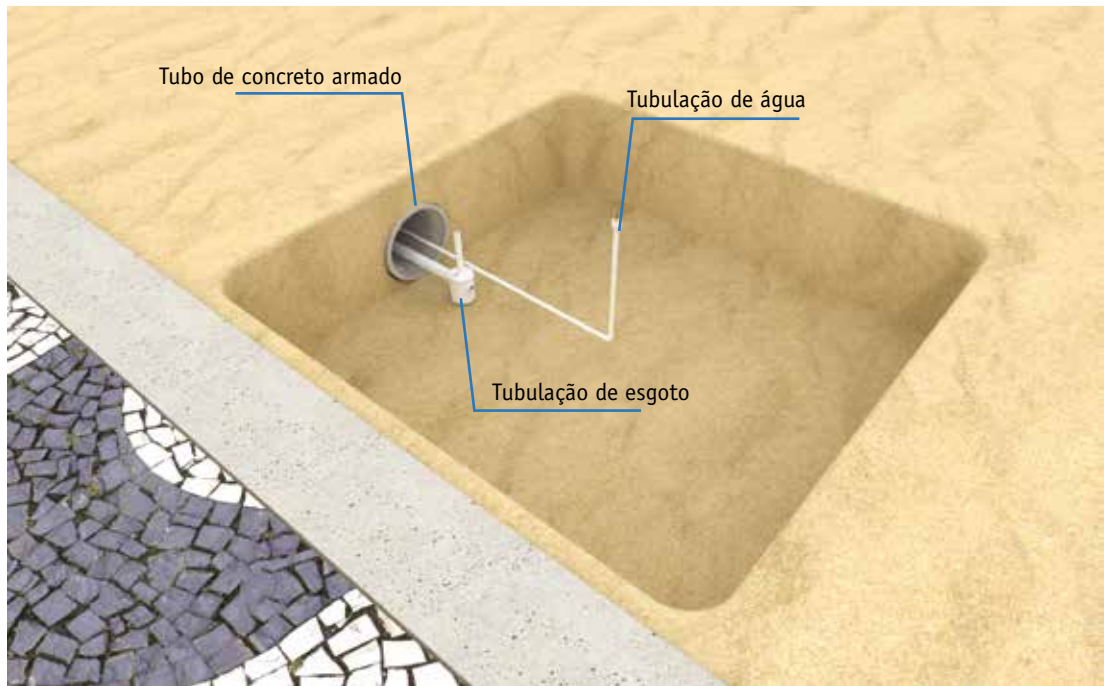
Buraco na areia para instalação do chuveiro. Fonte: Elaboração própria.
